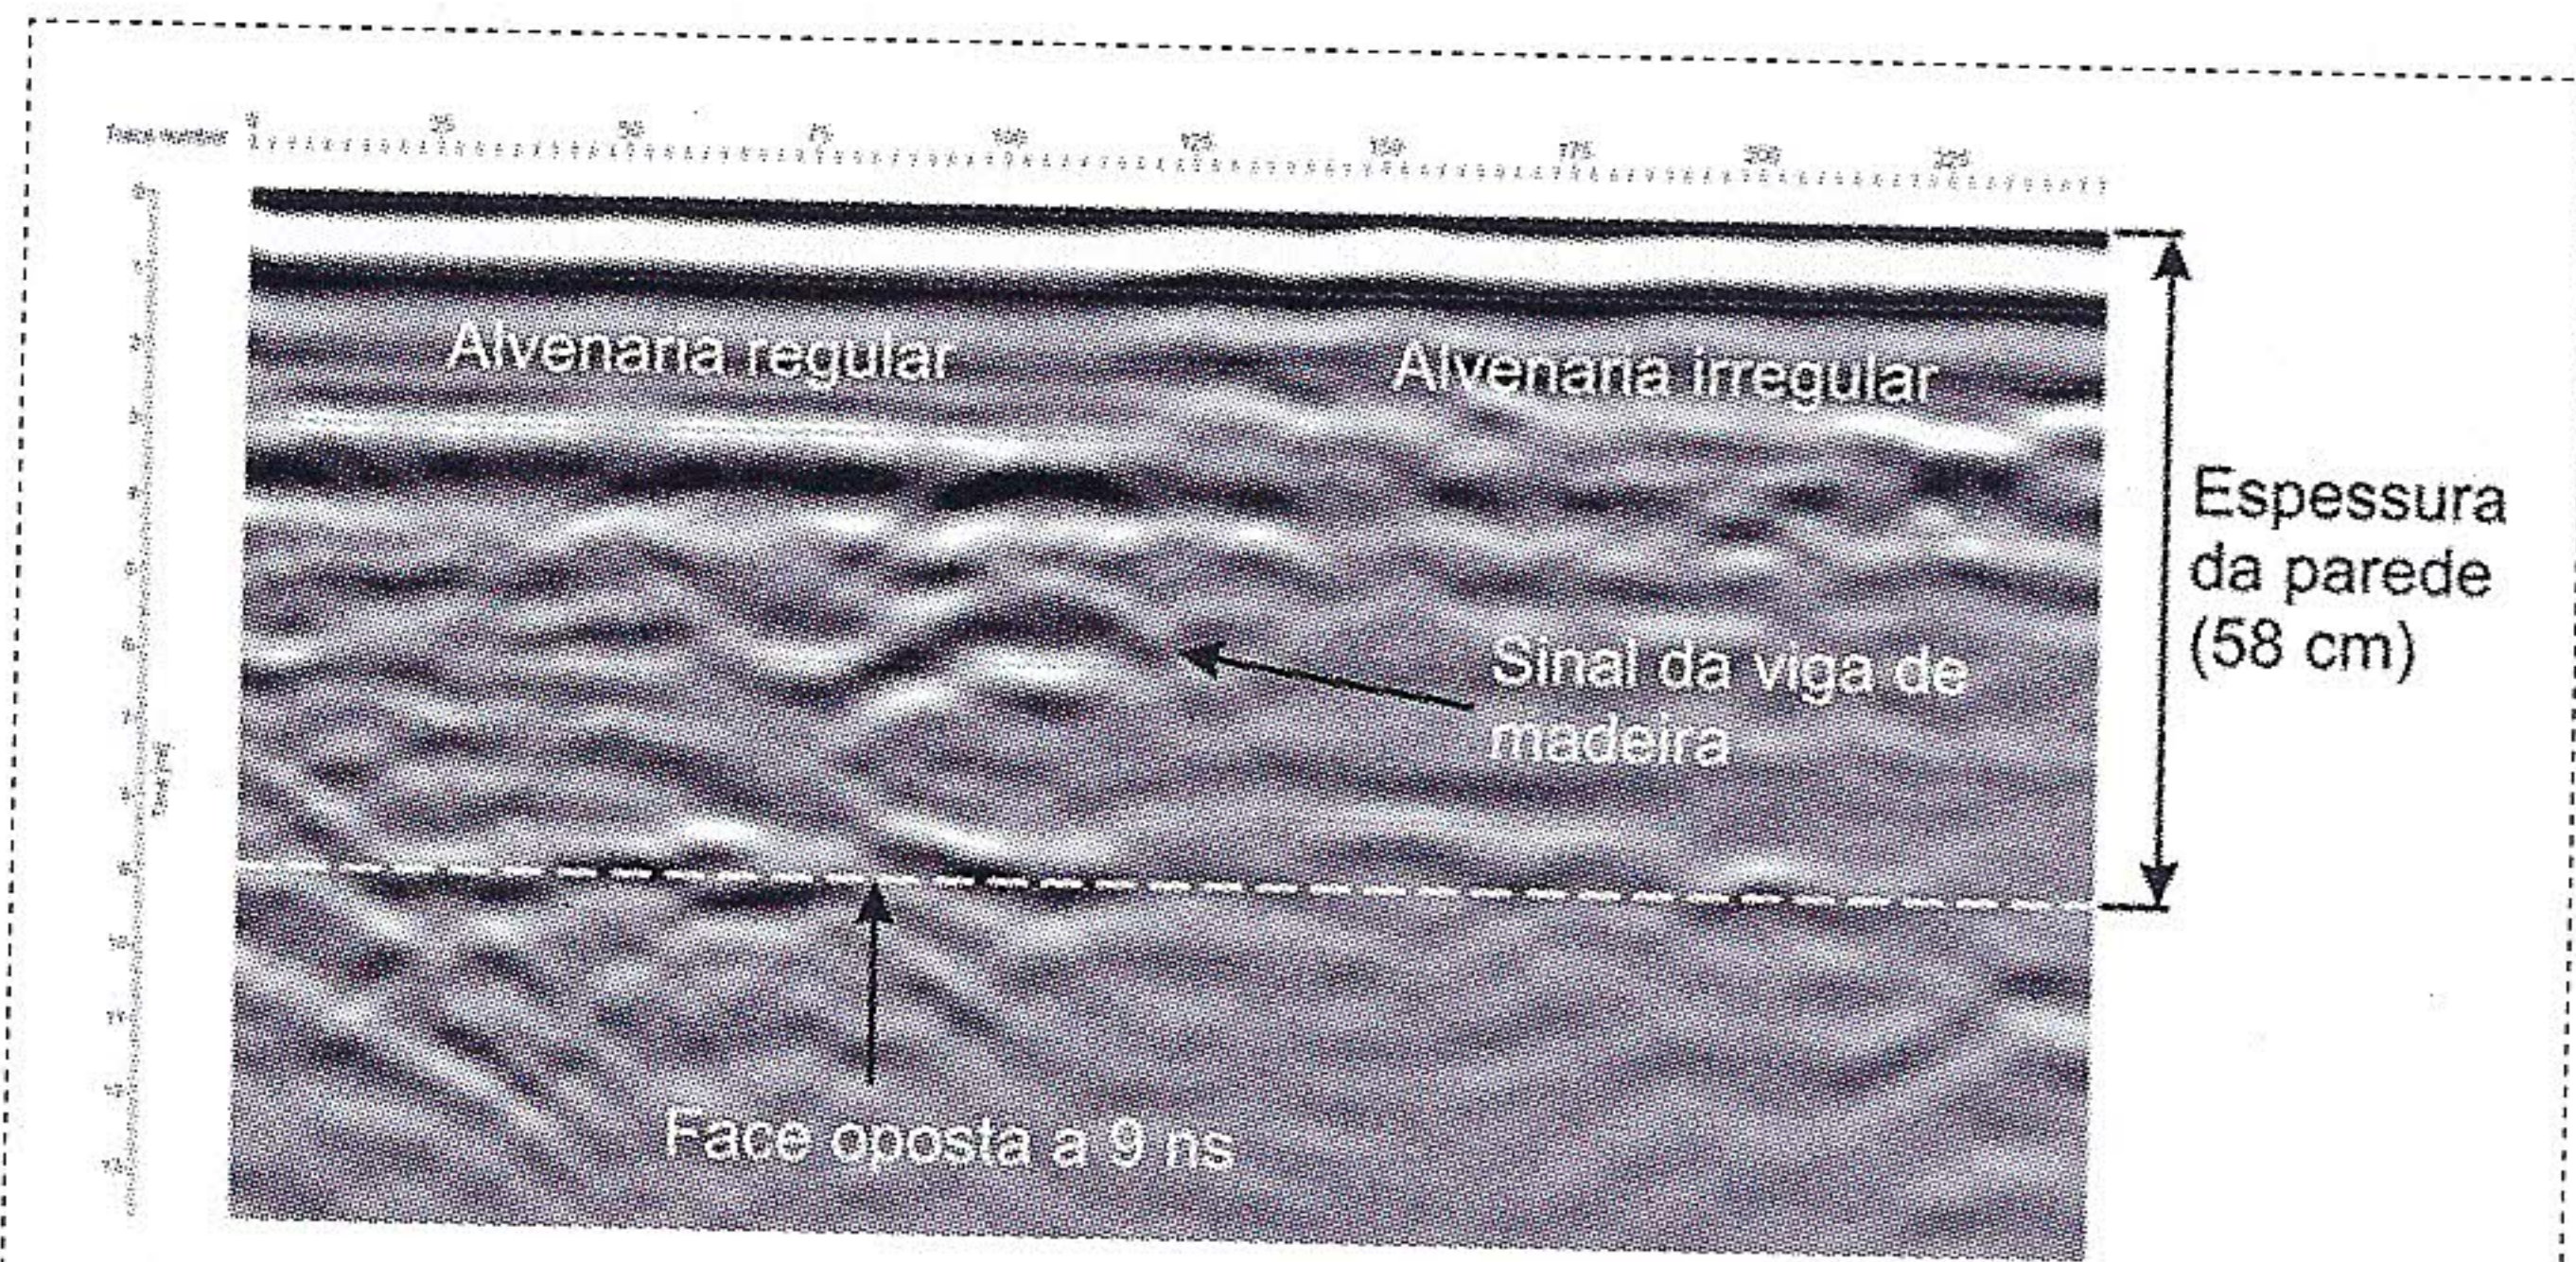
Detecção de viga de madeira embebida numa parede de alvenaria de pedra
